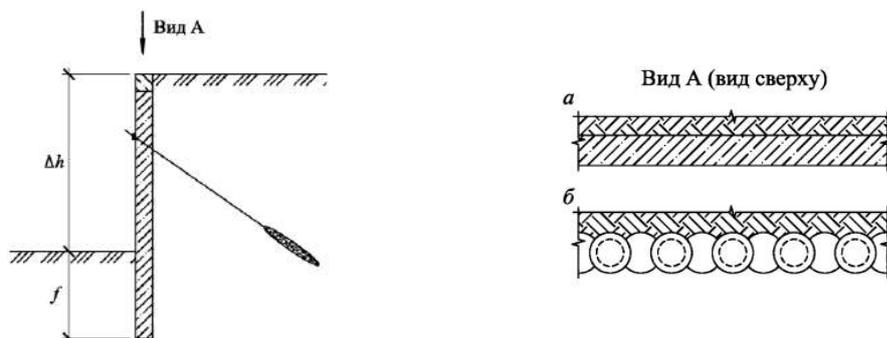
Гибкие подпорные стены: *a* – траншейная железобетонная «стена в грунте»; *b* – ограждение из буросекущихся свай; Δh – перепад высот; *f* – зона заделки
